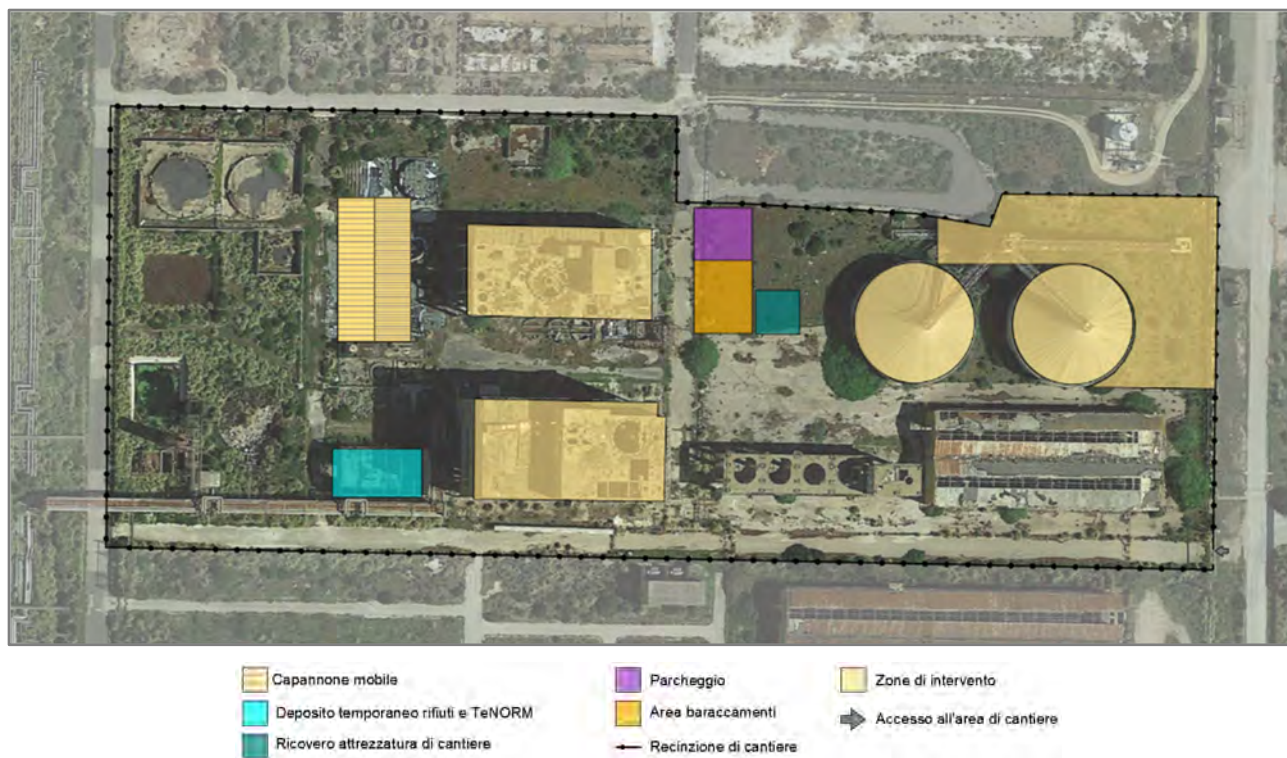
Vista dell'Area ex TPF con individuazione delle zone di intervento.
